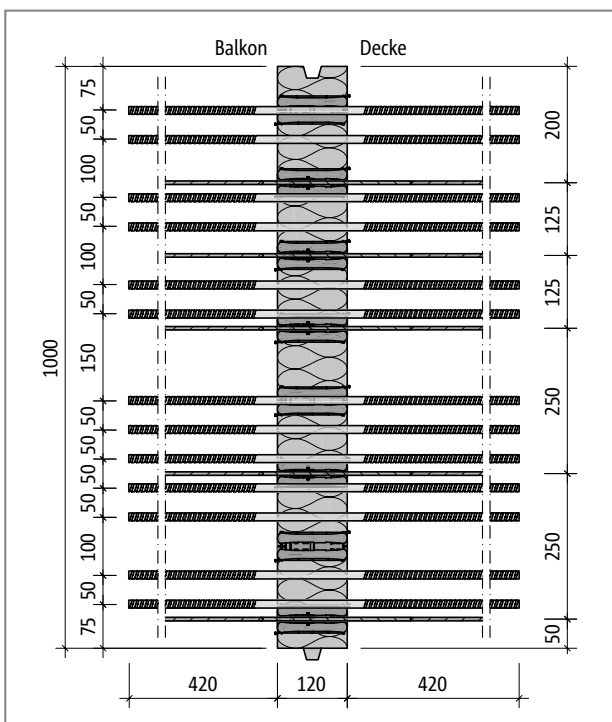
Schöck Isokorb® CXT Typ K-M6-V1: Produktgrundriss
